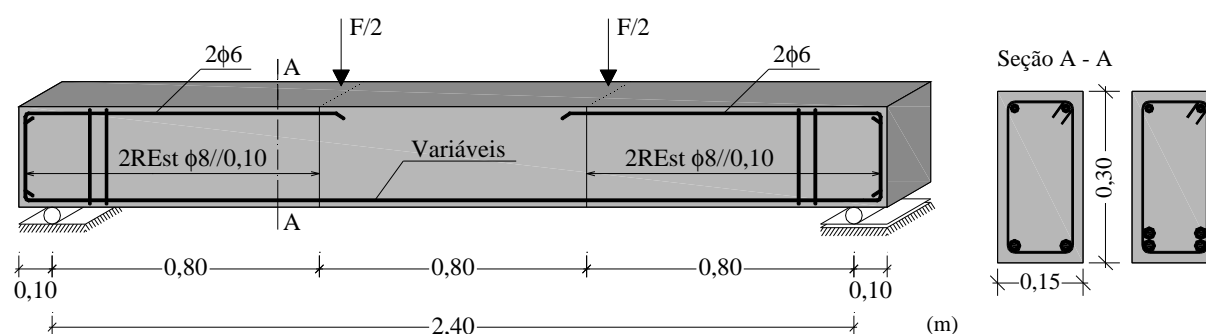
Corte longitudinal e transversal das vigas ensaiadas.
